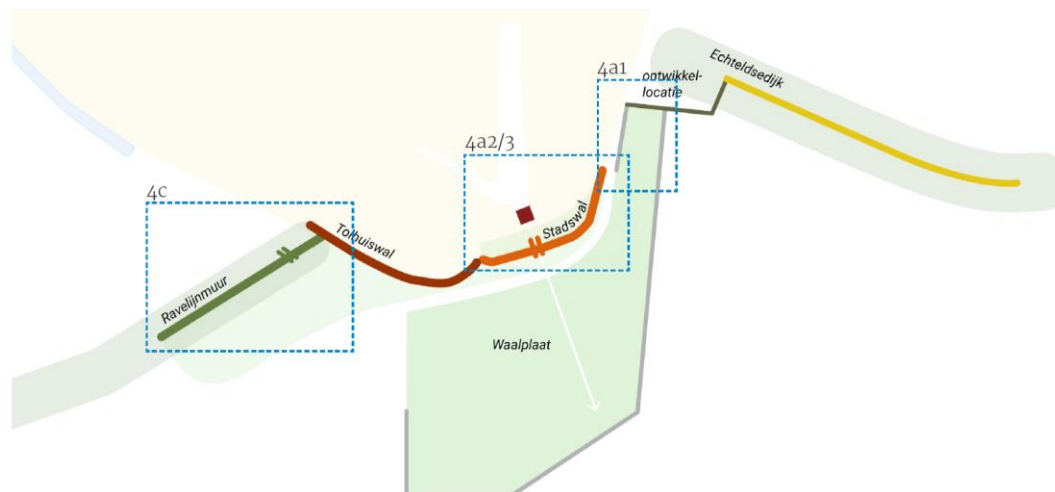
Bovenaanzicht dijkontwerp deeltraject 3B: Haven (Santwijckse Poort)
